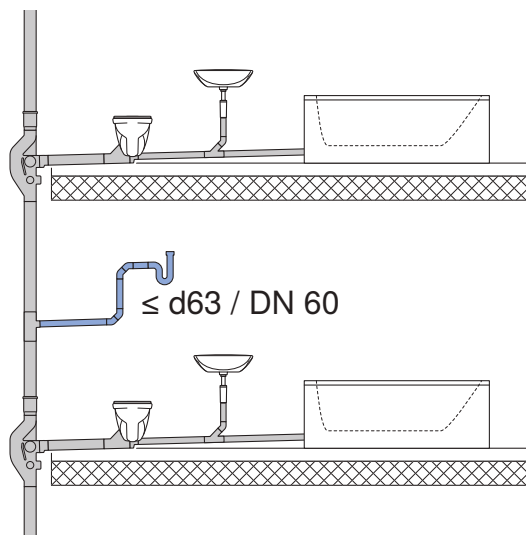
Niet toegestaan: gemengde installaties van Geberit Sovent fittingen met conventionele T-stukken in een standleiding
